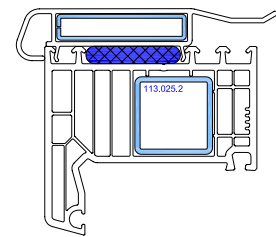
Darstellung von geteilten Fensterkonstruktionen mit Rollladenanlagen und Anschluss an ein Loslager
